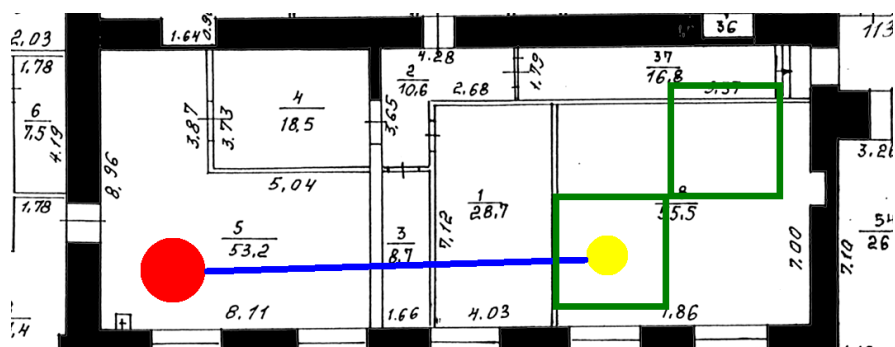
Пример плана этажа для расчета. Стены – бетон.
